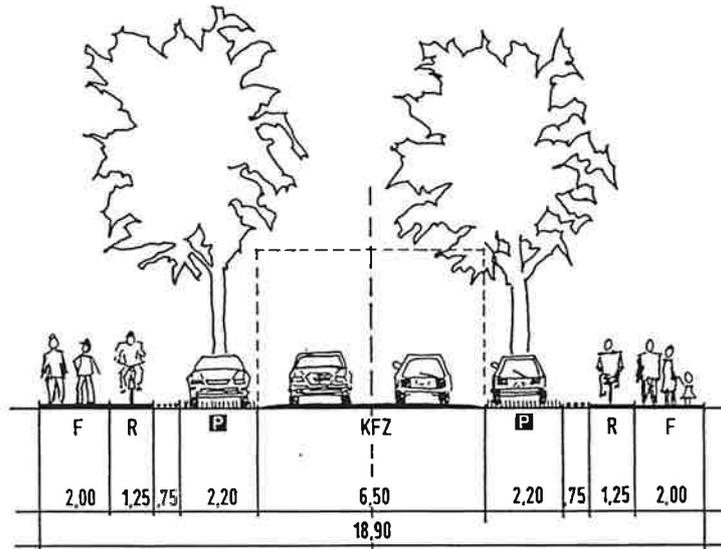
HAUPTSAMMELSTRASSE, ERNST-SCHNELLER-STRASSE, A₆-A₆
